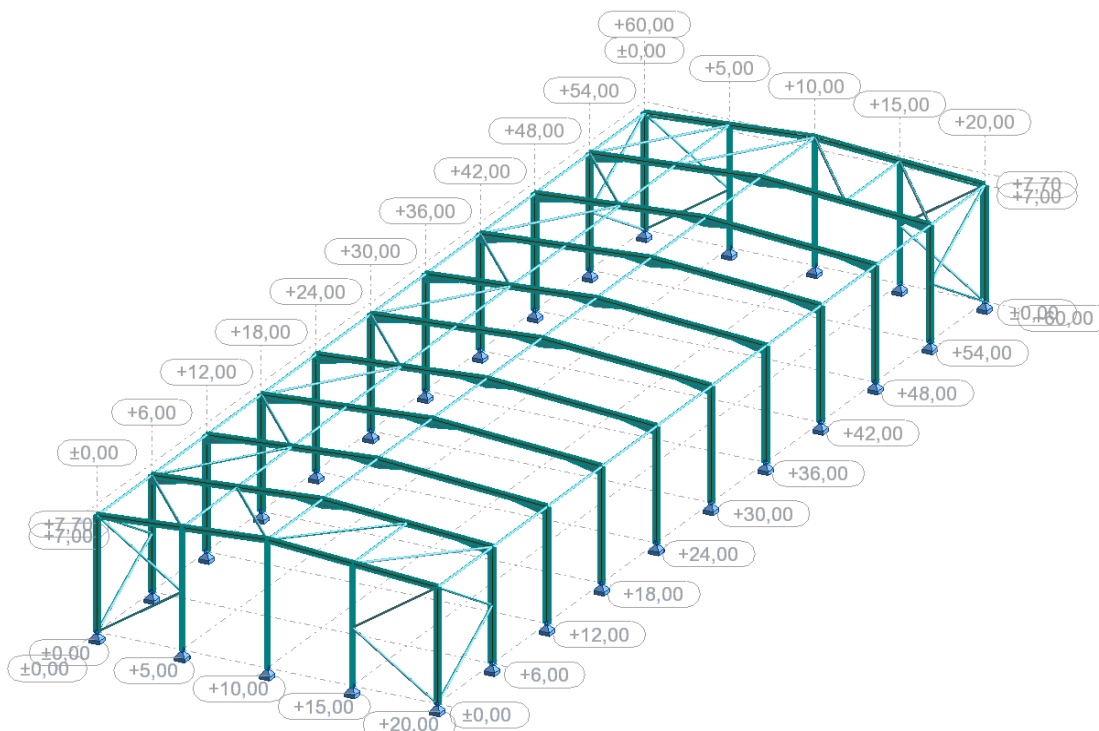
Exemplo do contraventamento aplicado - vista 3D (caso de estudo PF20-6)
